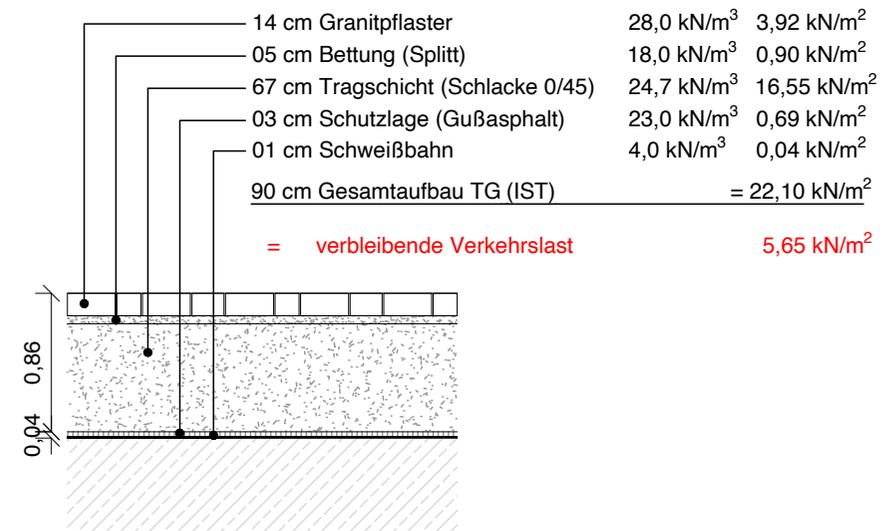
Bestandsaufbau von rund 0,90 m auf der Tiefgaragendecke des Marktplatzes (o.M) mit entsprechenden Auflasten (nach Angabe RS-Ingenieurgesellschaft/Abteilung Tiefbau Stadt Offenburg)
